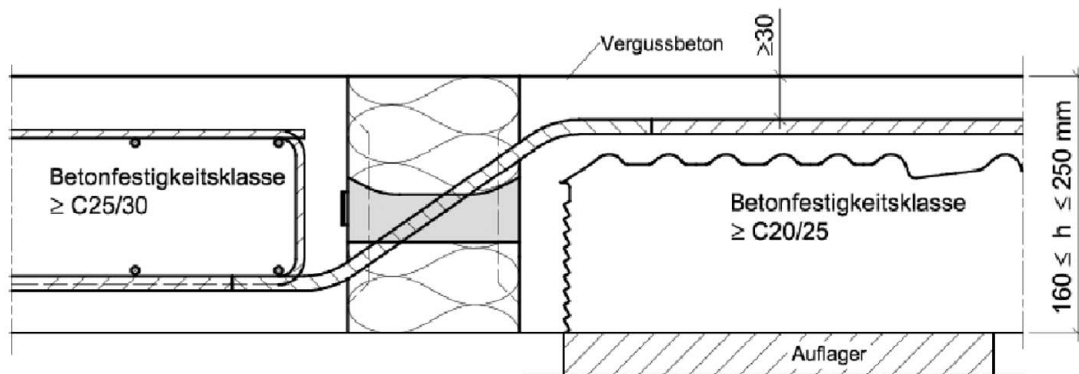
Beispiel Schöck Isokorb® XT Typ Q-ID mit Betondrucklager in eingebautem Zustand mit Vergussfuge
